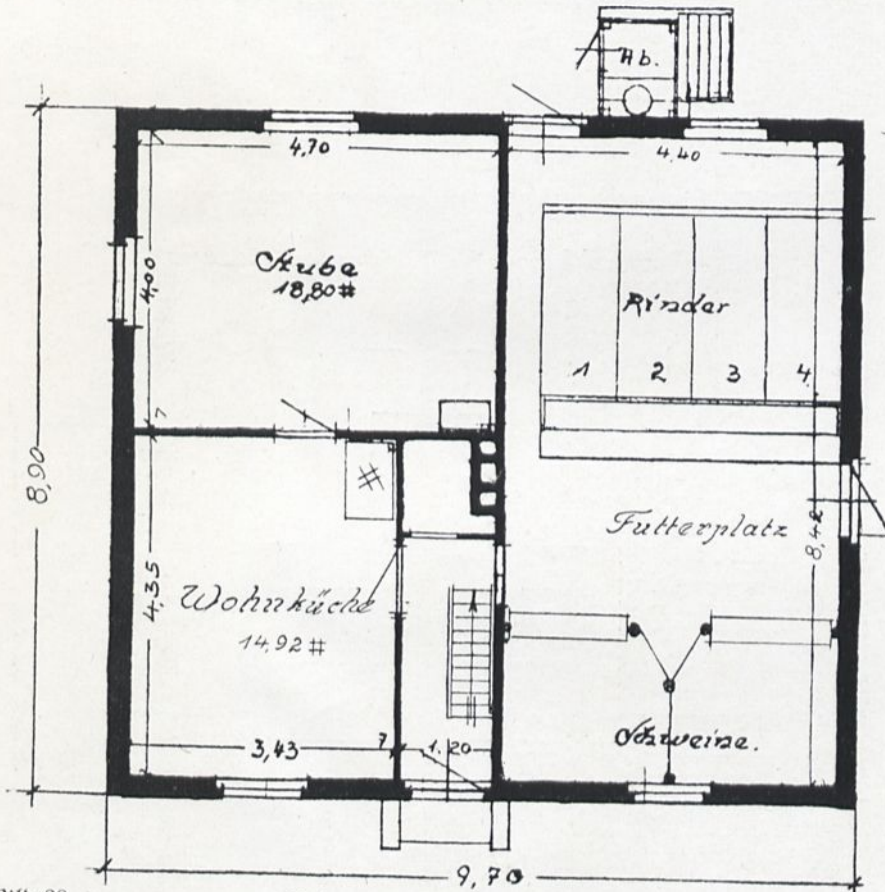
Wohn- und Stallgebäude nach Typ „P 4“ (Primitivbauten)
